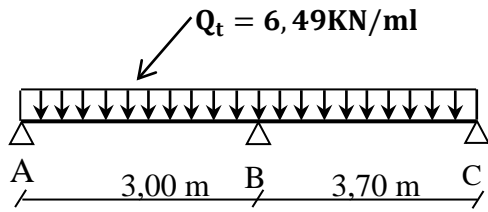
Poutrelles à 2 travées (plancher terrasse)
